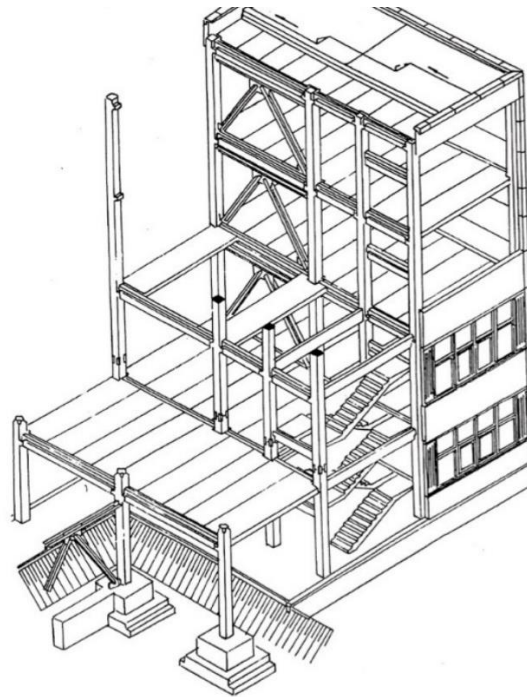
Многоэтажное здание со связевым железобетонным каркасом по серии 1.020-1.83.
